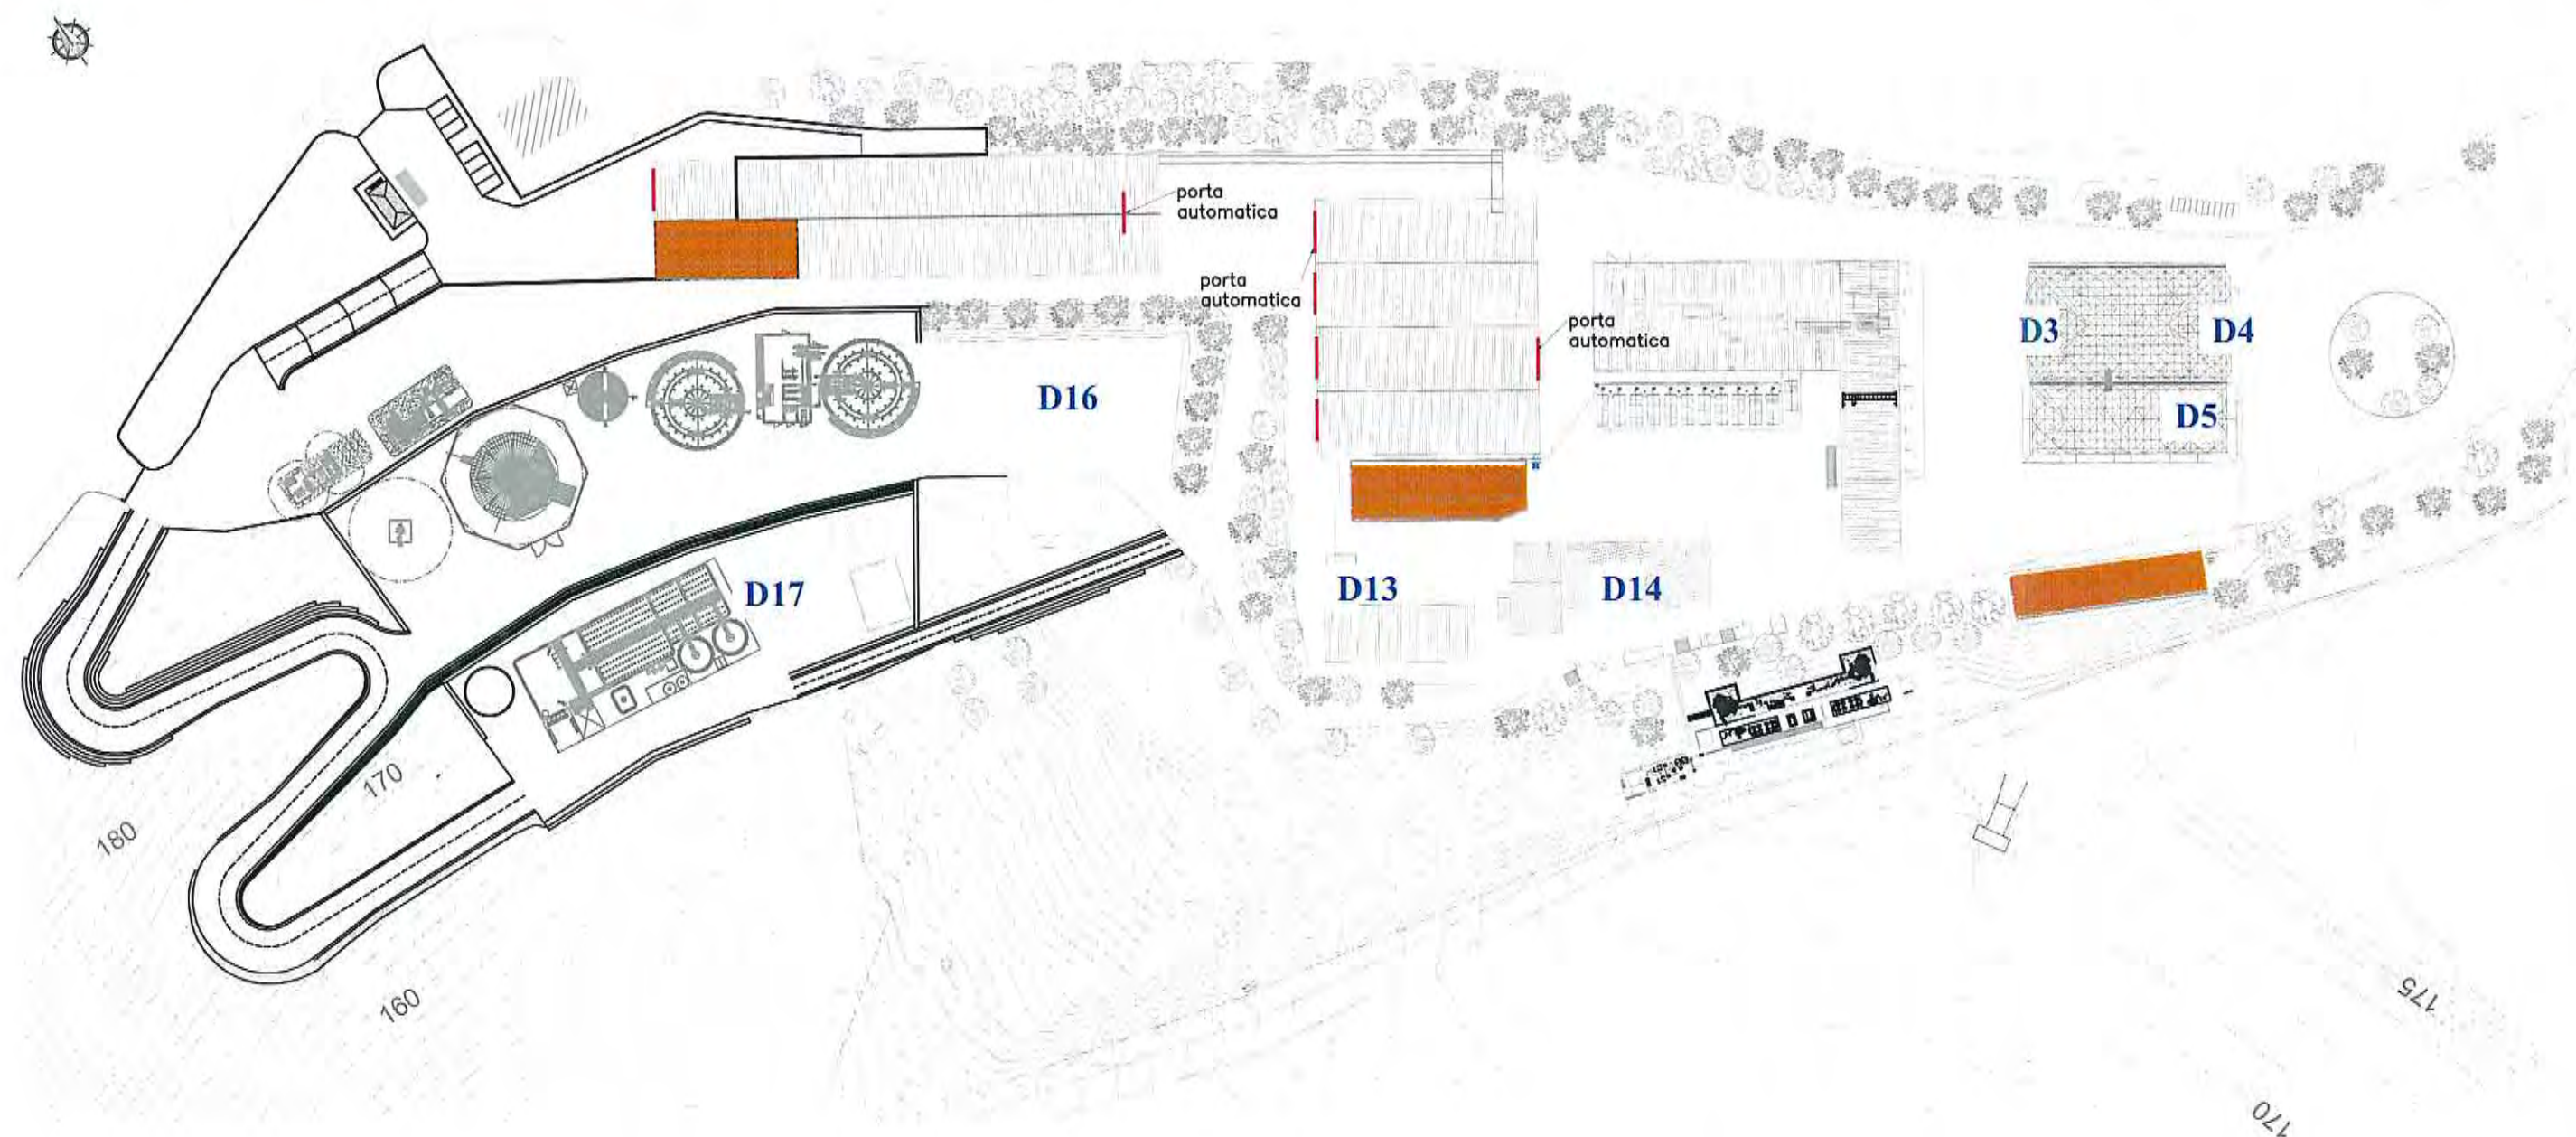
Planimetria con individuazione emissioni diffuse stato modificato
